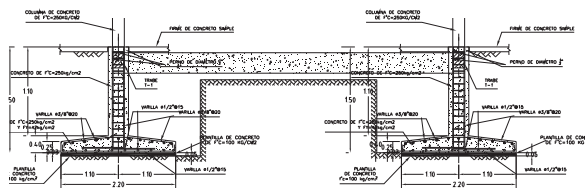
Zapatas aisladas de concreto armado, ligadas con dalas de concreto armado. ⁴⁰
